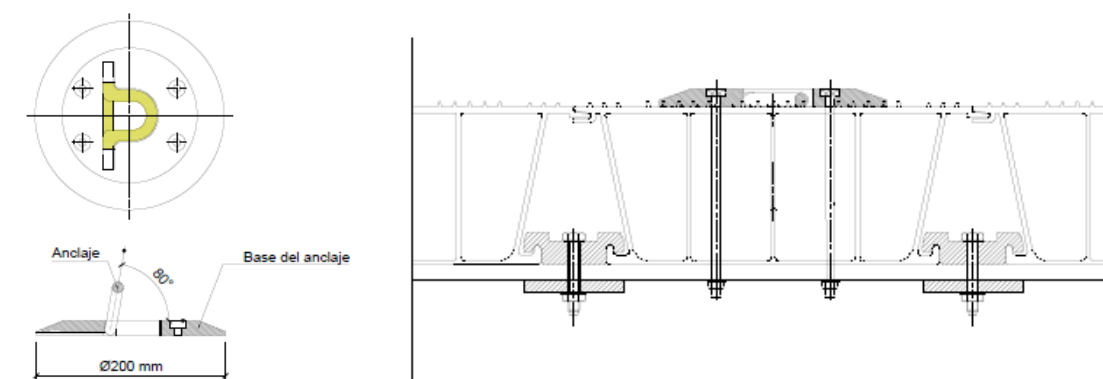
Punto de amarre en panel de aluminio del tablero. Fuente: Propia.
